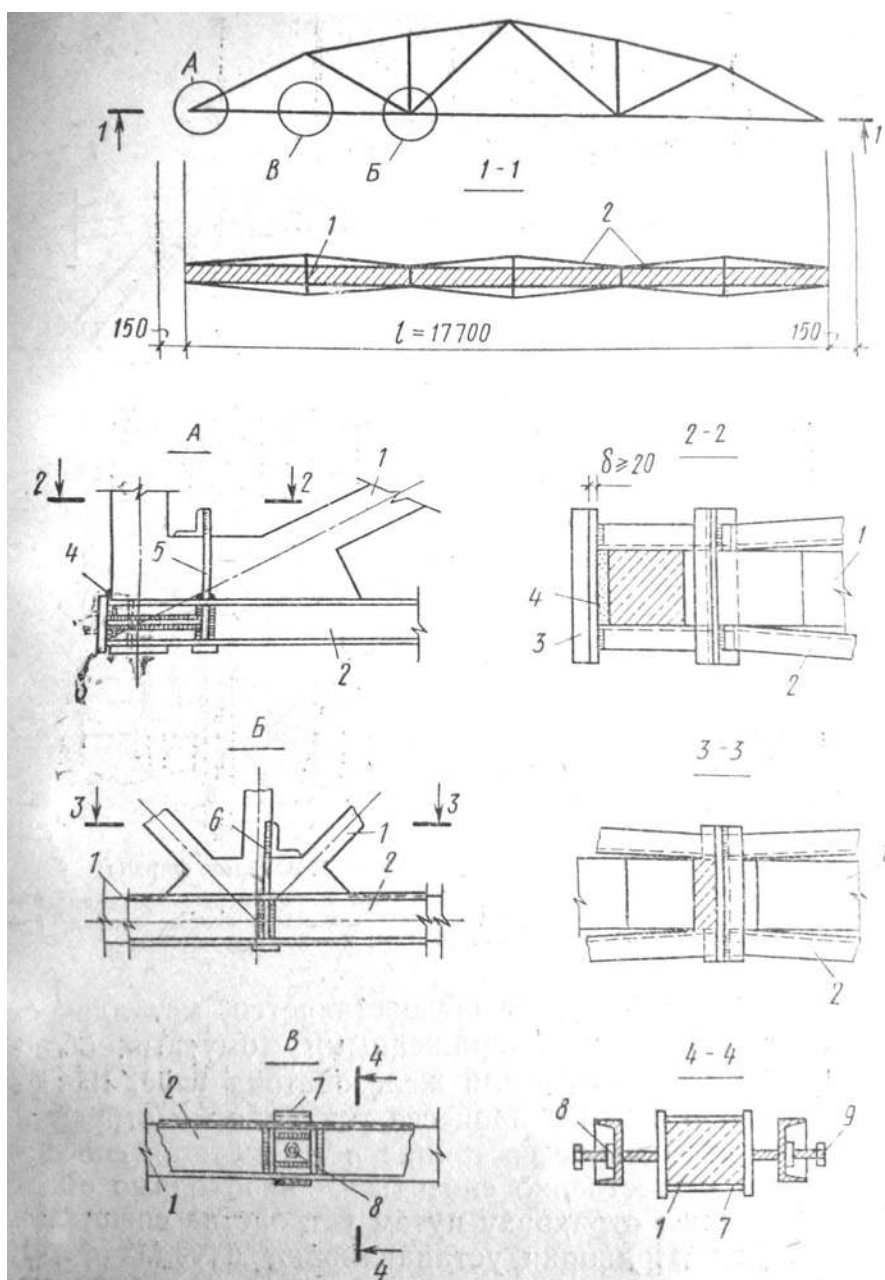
Усиление нижнего пояса стропильной фермы затяжками из швеллеров:
